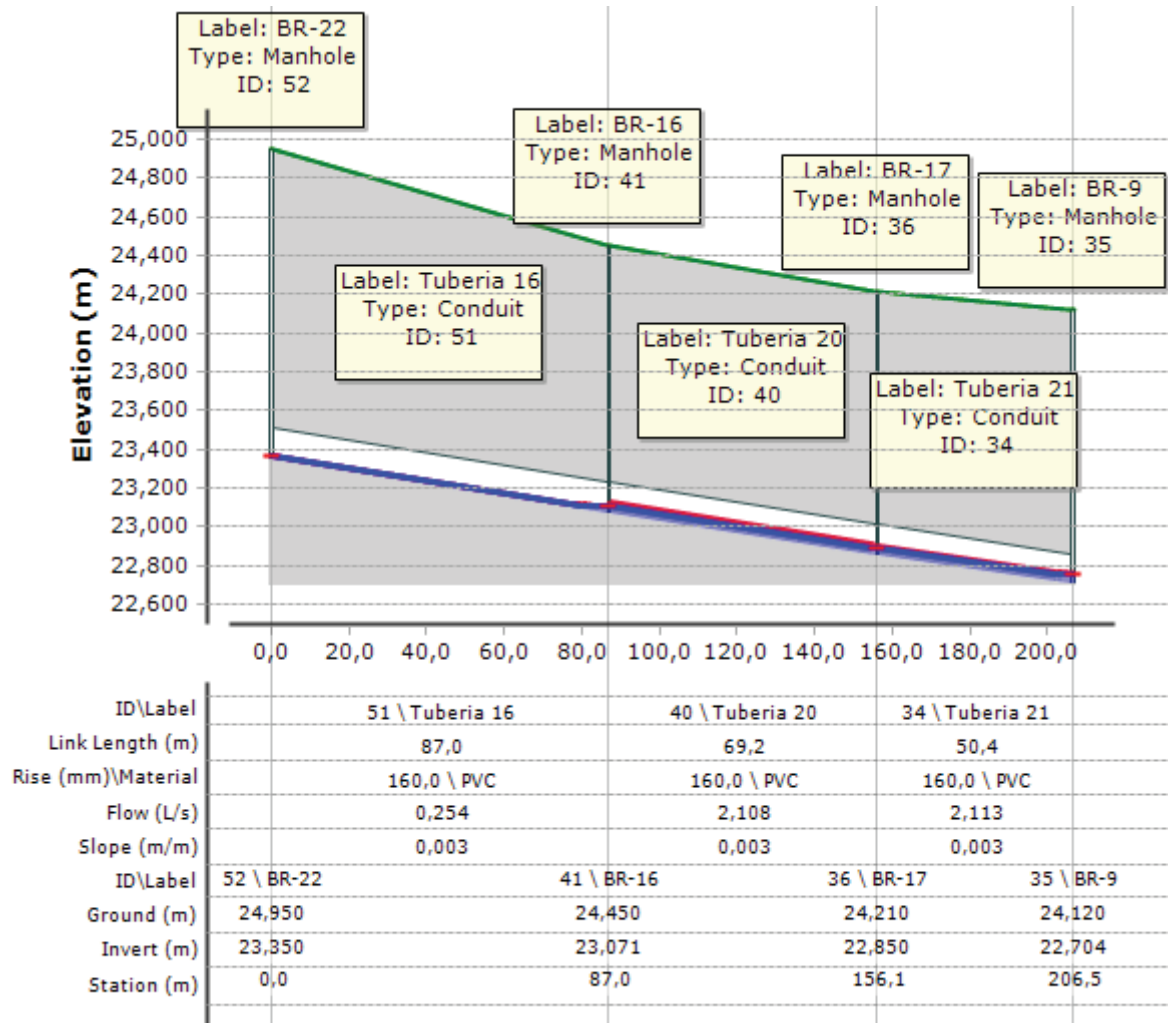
Perfil hidráulico tramo BR-22 a BR-9
